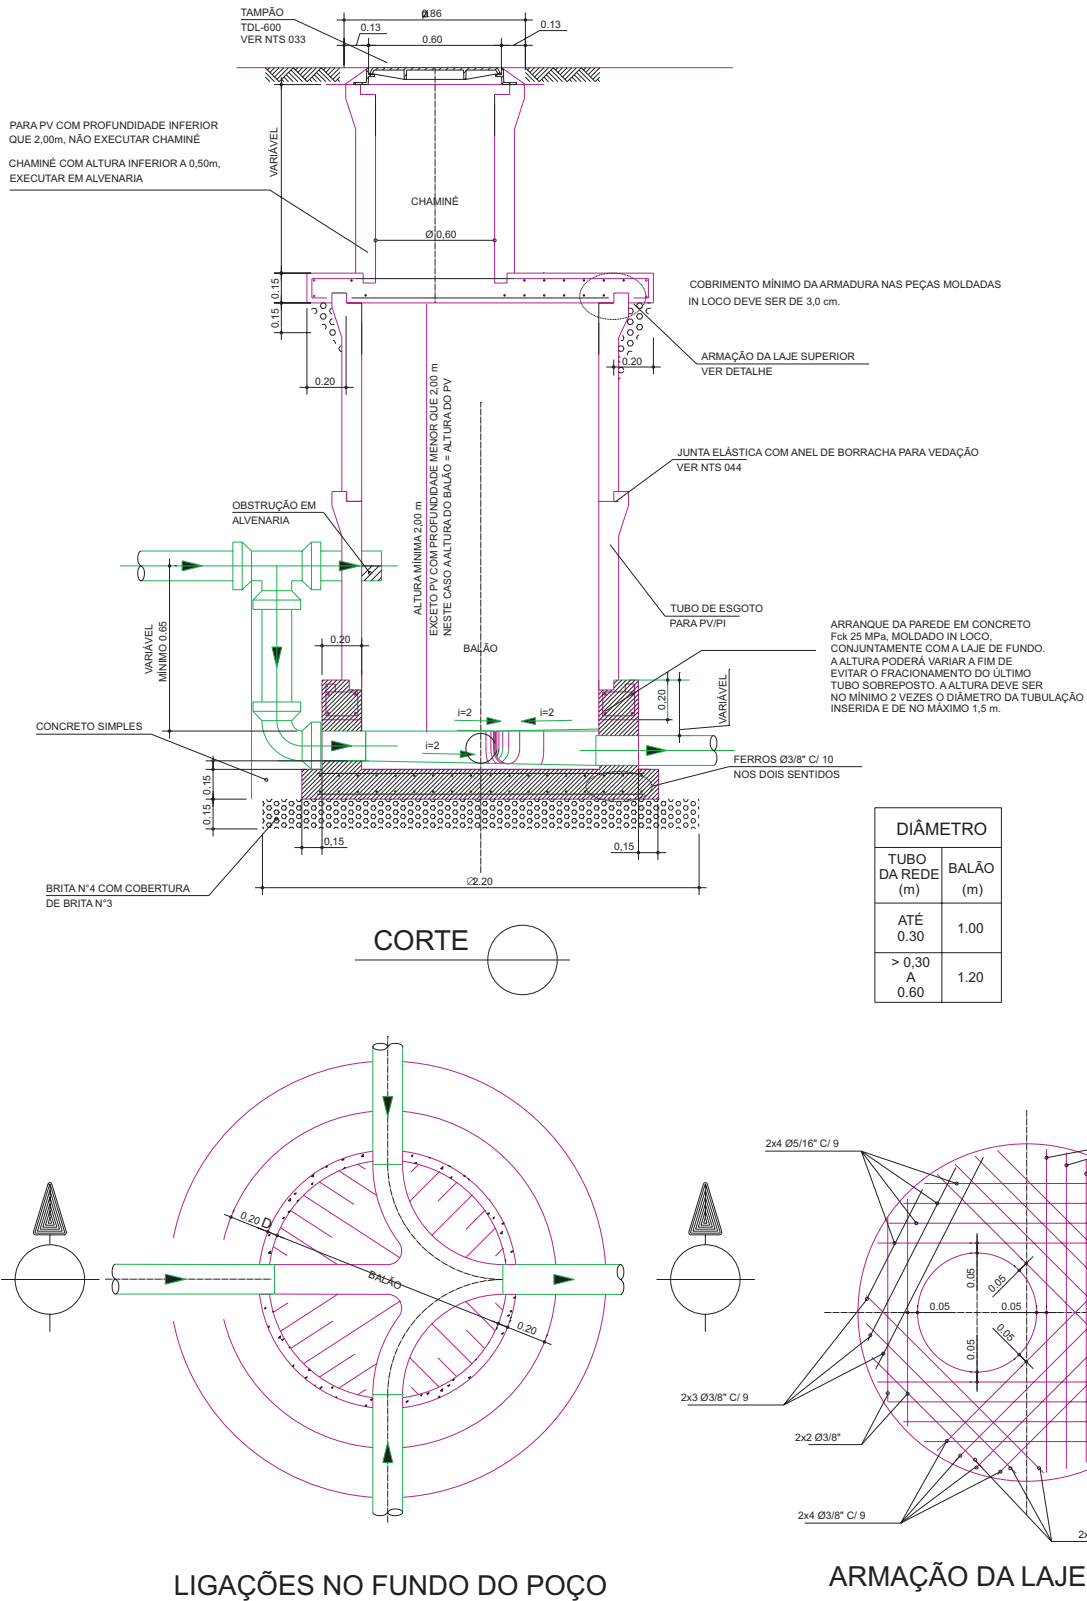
Poço de visita convencional em tubos de concreto ponta e bolsa junta elástica, com tubo de queda externo. (Sabesp, 2006)
